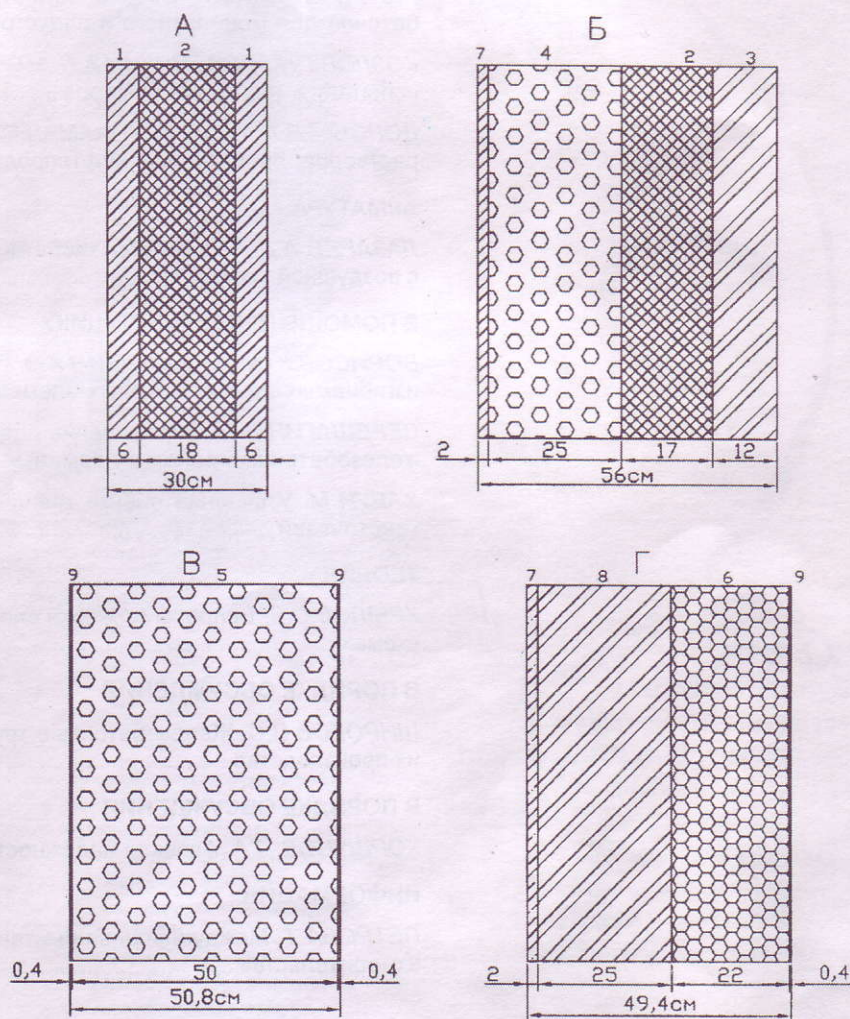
Конструкции наружных стен жилых зданий с конструкционными слоями из
